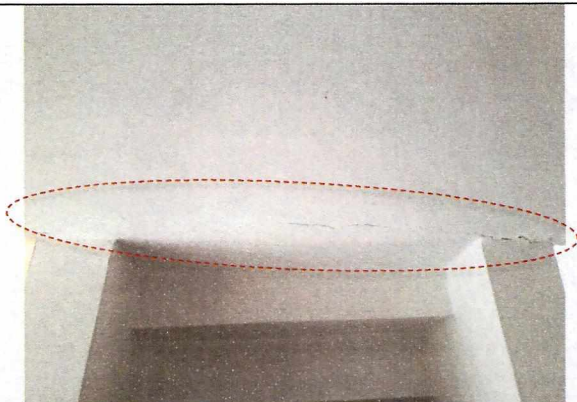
Grieta sobre el muro perimetral del costado occidental – fachada principal del predio.
